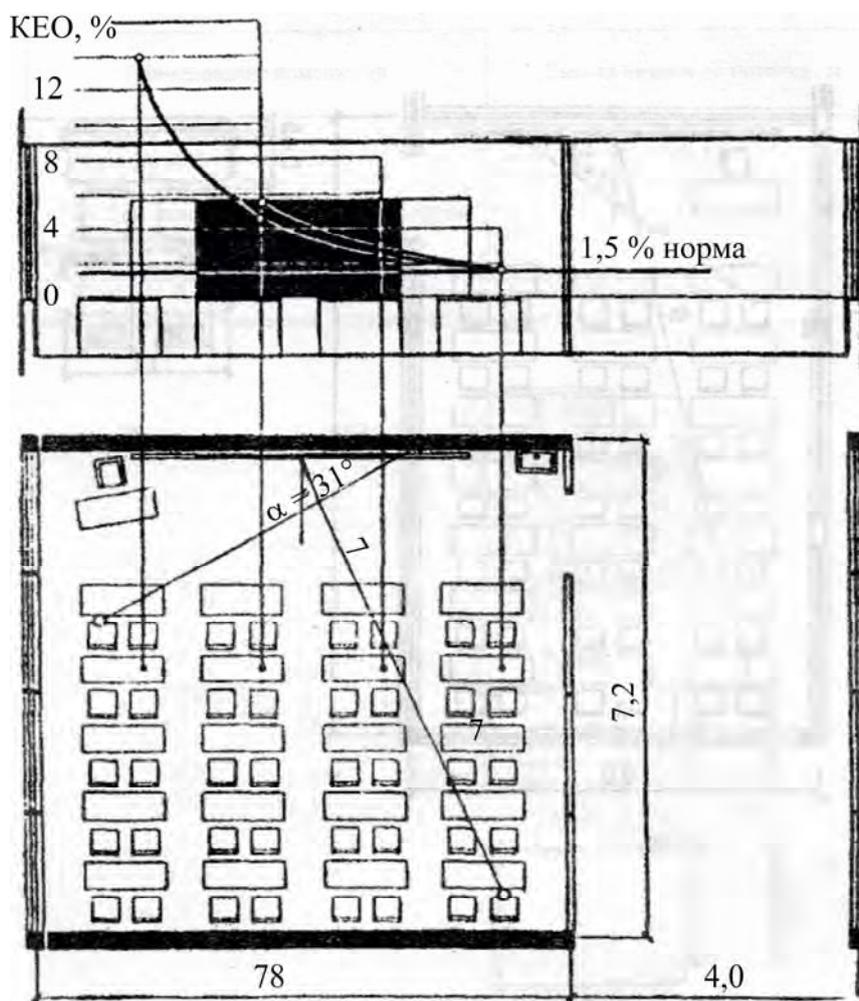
Поперечный разрез и план квадратного класса школьного здания панельной конструкции: в плане показаны точки, для которых определяется коэффициент естественной освещенности; α — угол зрения 30...33°
